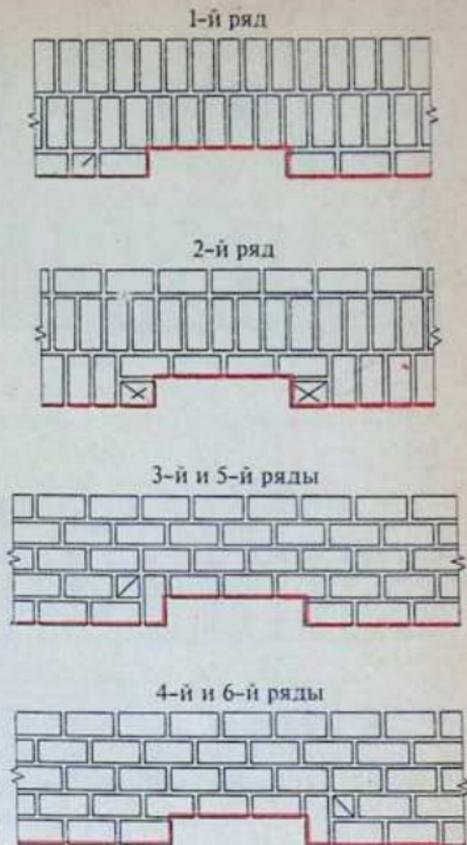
Кладка стены с нишей при многорядной системе перевязки.
